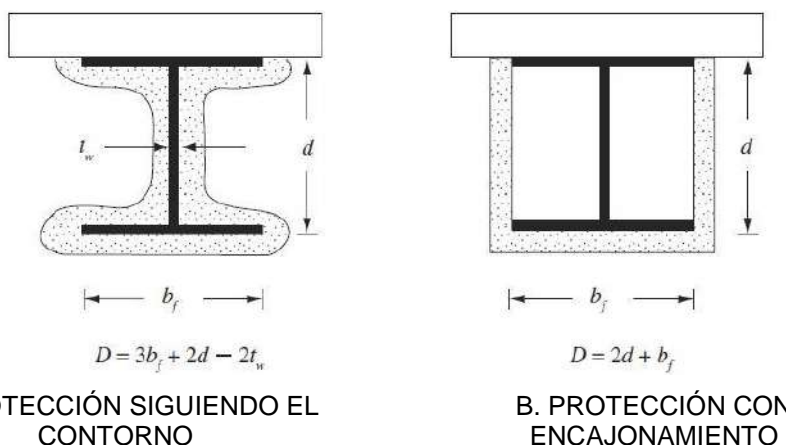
Determinación del perímetro expuesto al fuego de vigas y viguetas de acero
